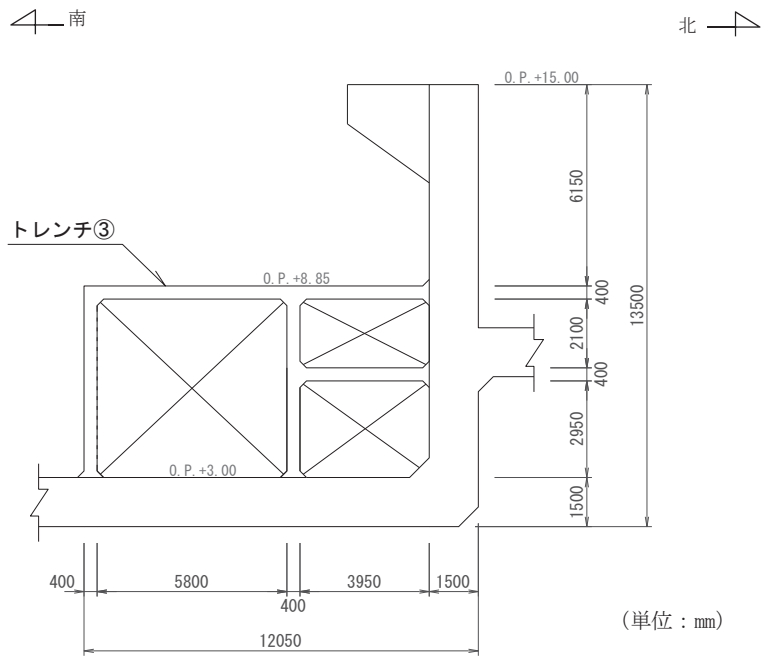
(9) 補機ポンプエリア断面図 (⑨—⑨断面)
